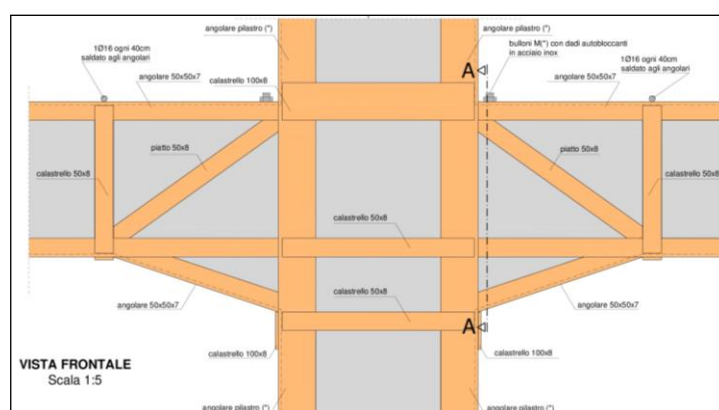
particolare di progetto riguardante un nodo trave pilastro, confinato con angolari e calastrelli, e successivo getto di SCC
